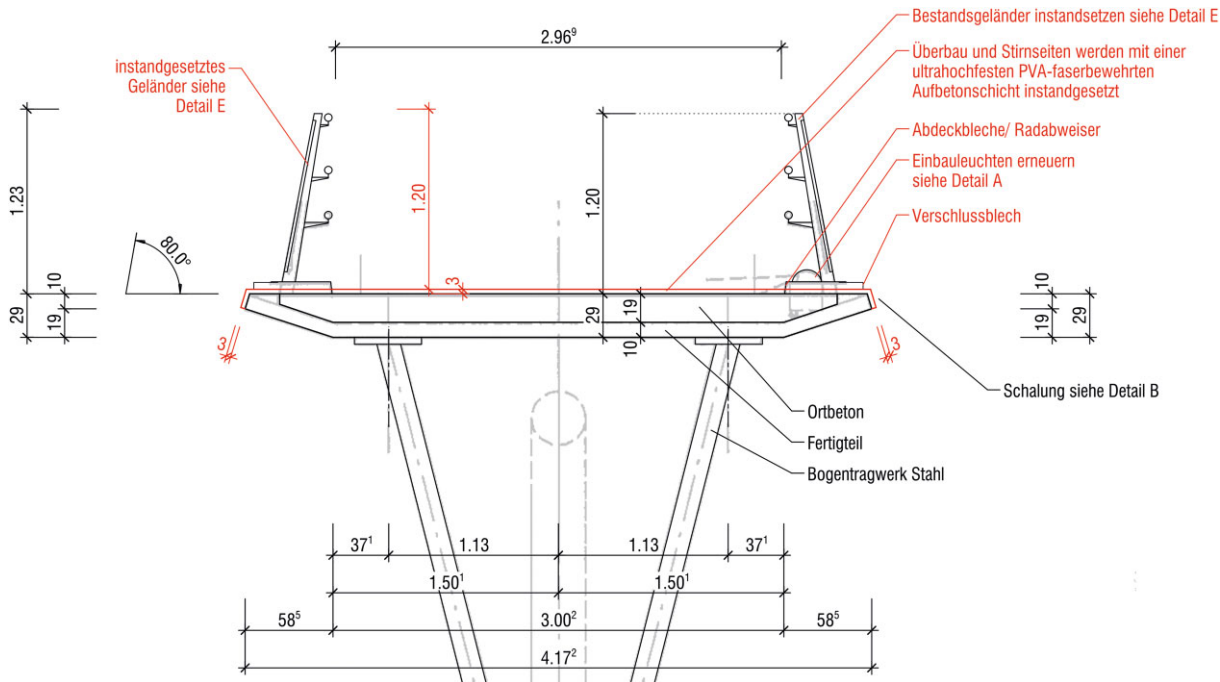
UHPB-Schicht als Abdichtung und direkt befahrbares Brückendeck
